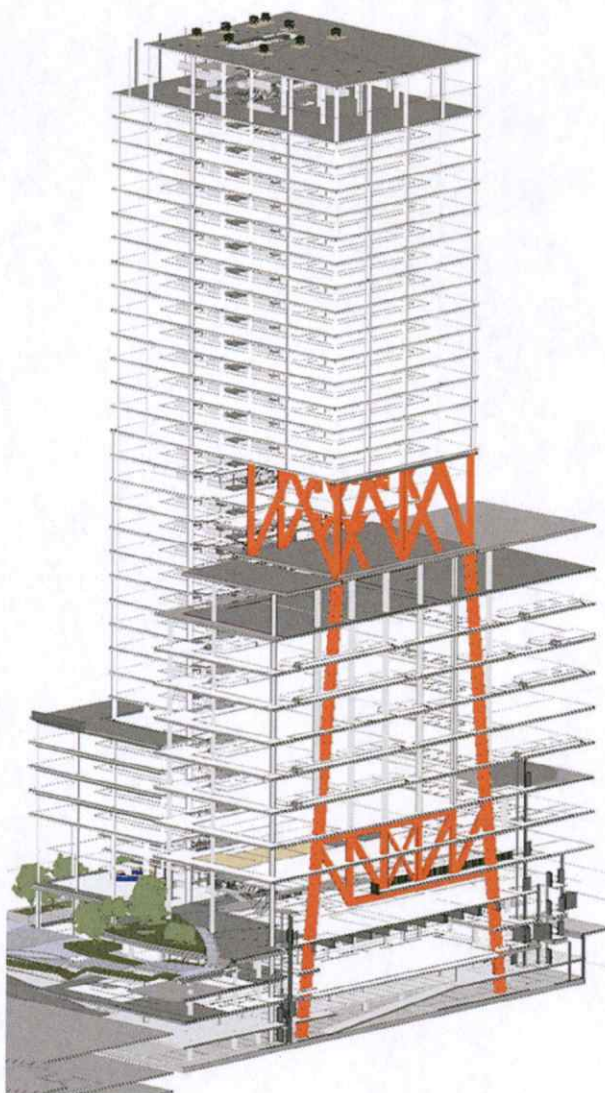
Méga structure avec poutres-treillis du projet amendé
